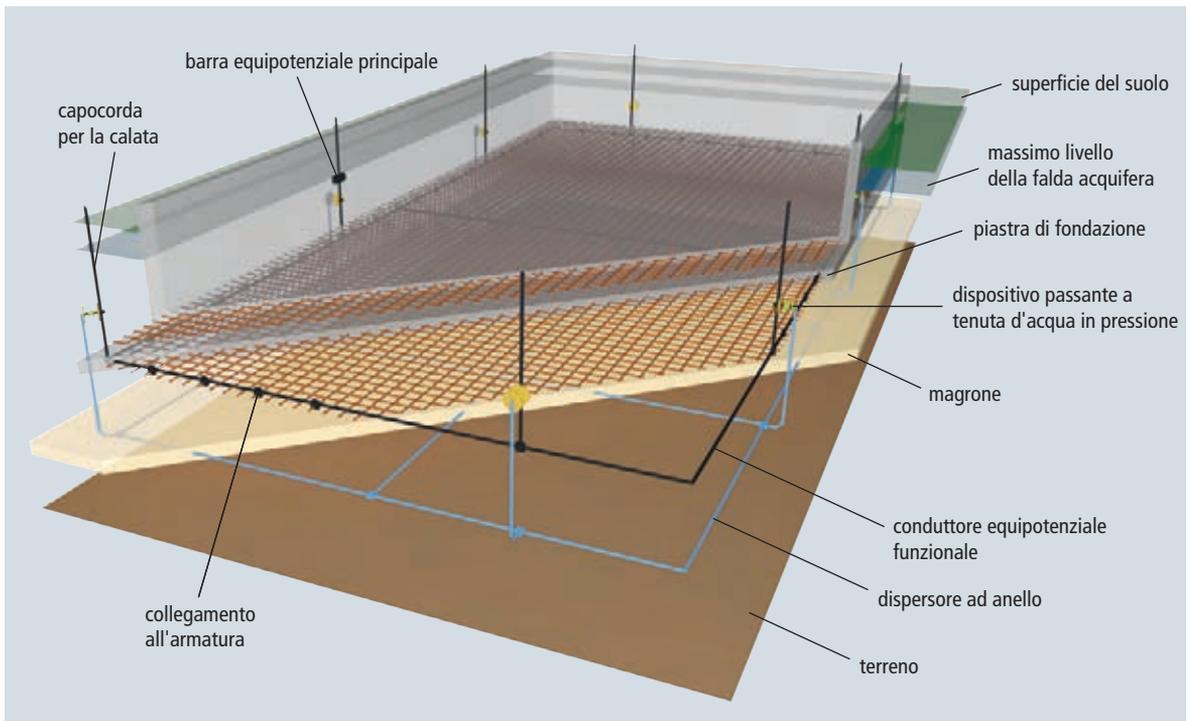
Rappresentazione tridimensionale che illustra il dispersore ad anello, il conduttore di collegamento equipotenziale e i collegamenti tramite dispositivi passanti a tenuta d'acqua in pressione
